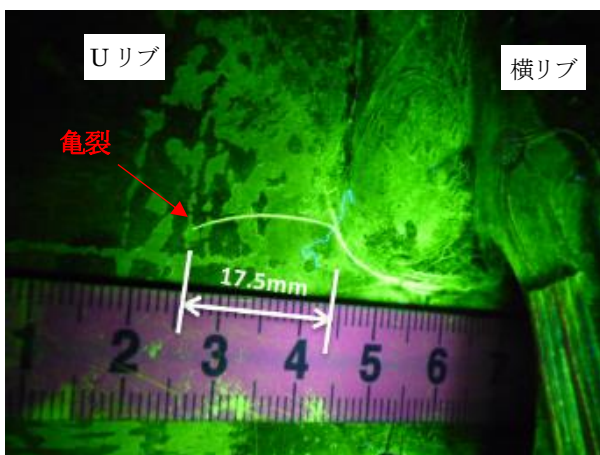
試験終了時の亀裂状況 (ゲージ⑤東側)
